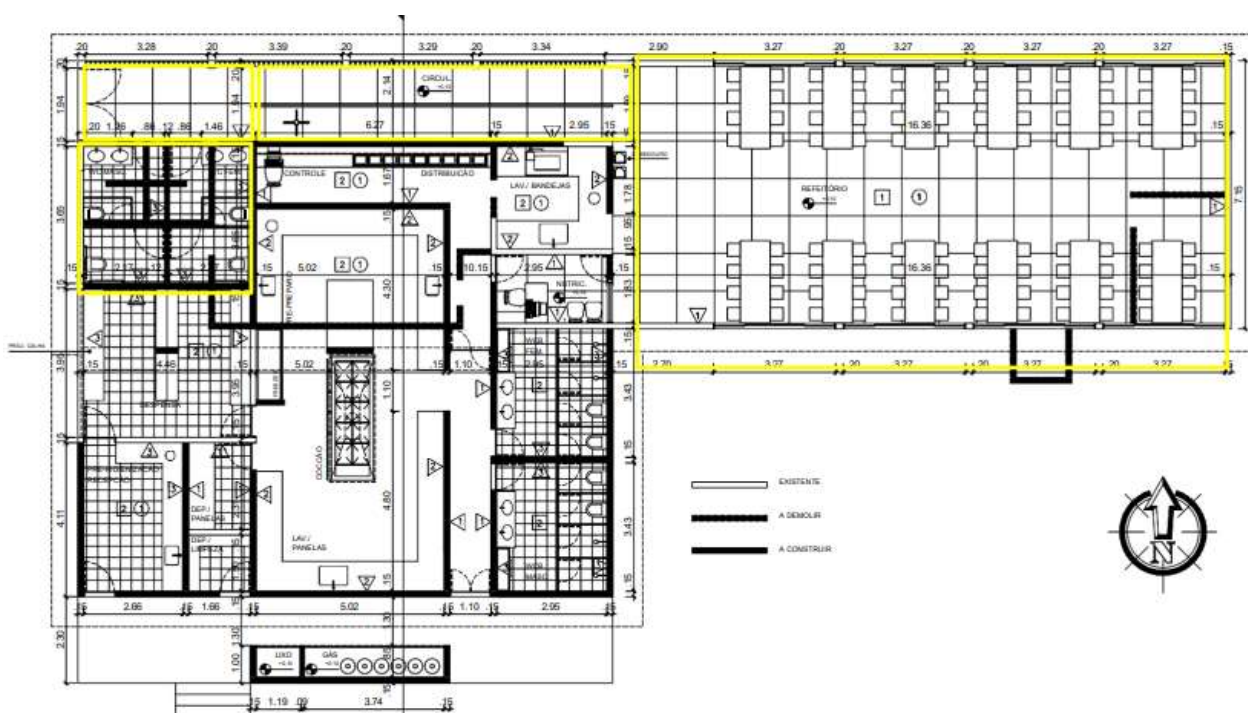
Planta Baixa da Edificação. Fonte: PU/UFMG
